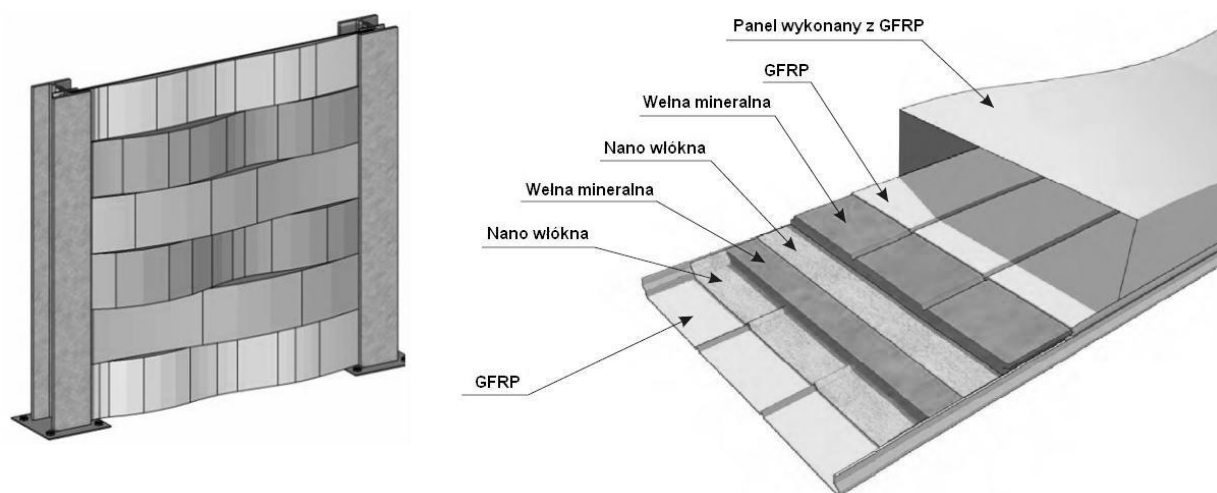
Przekrój poprzeczny jednego z elementów kompozytowych systemu barier bezpieczeństwa.
